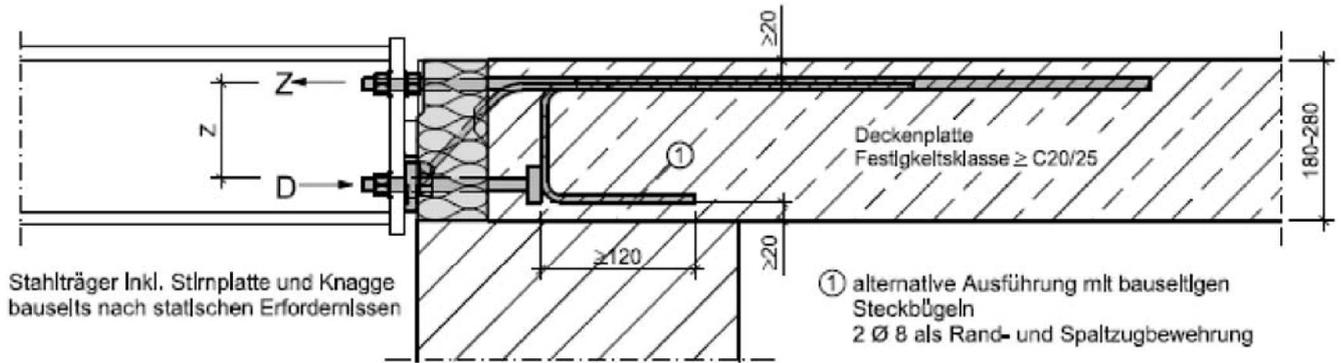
Schöck Isokorb® T Typ SK-M1-V1 und T Typ SK-M1-V2
